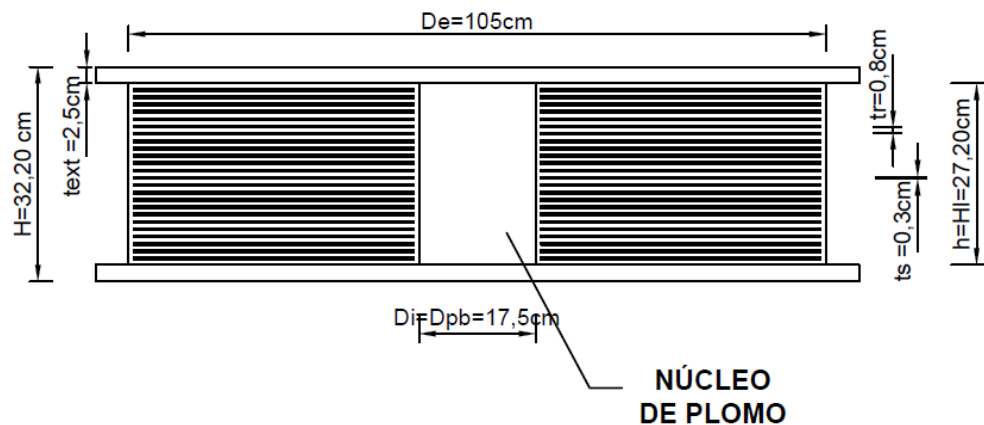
Esquema de configuración del Aislador LRB - Elevación
